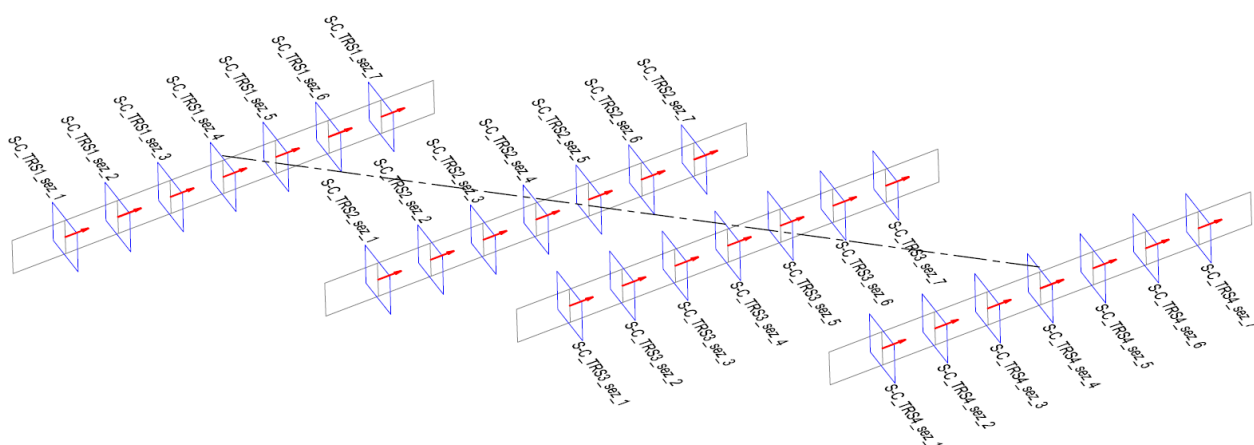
Posizione Section Cuts sui trasversi – Vista assonometrica
